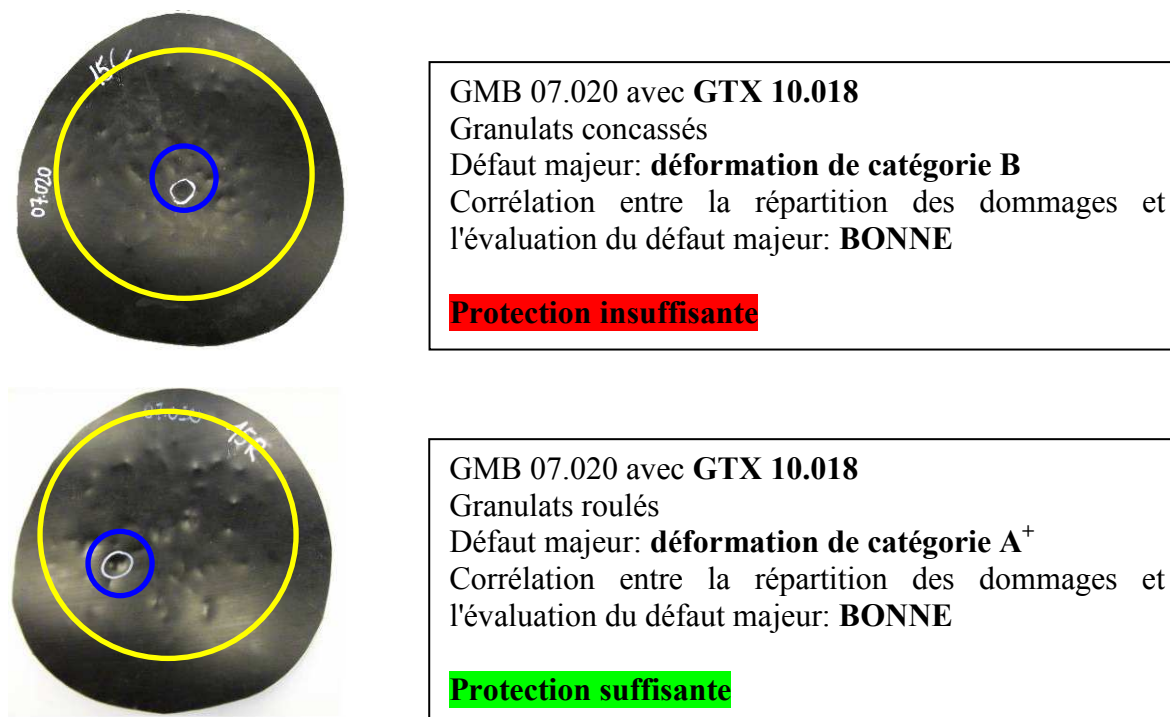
Observations visuelles détaillées sur l'essai d'endommagement statique
